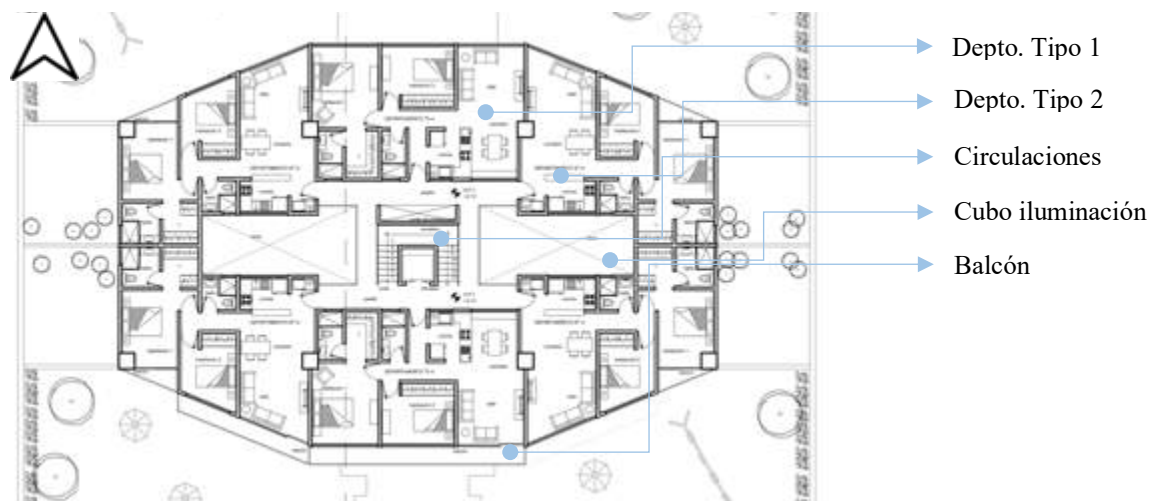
Planta tipo, torre sur, central y norte. Fuente: Elaboración propia.
